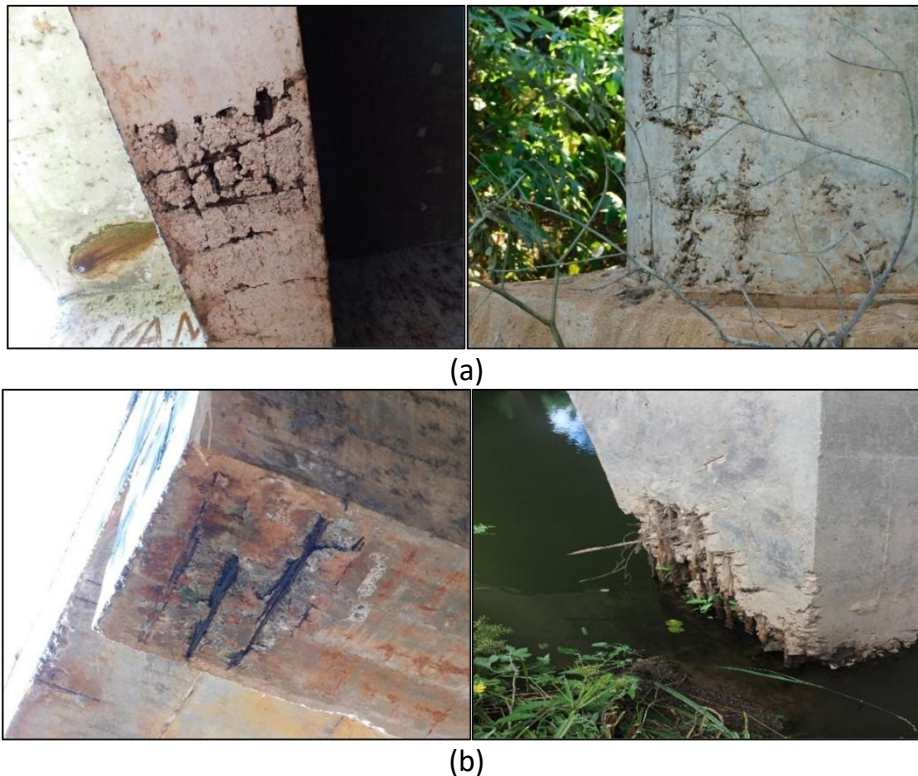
(a) Nicho de concretagem na estrutura; (b) Armadura exposta na estrutura.
